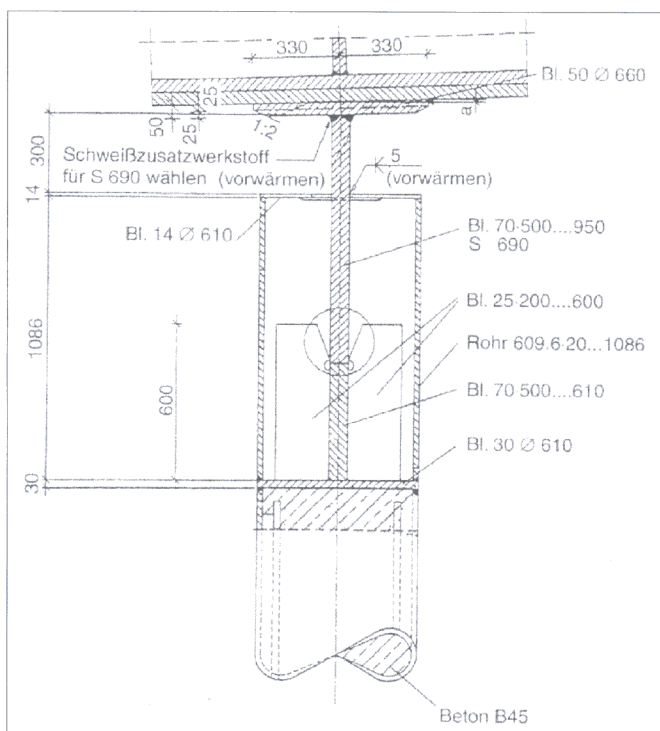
Stützen mit Übergang der Brücke GVZ Ingolstadt
